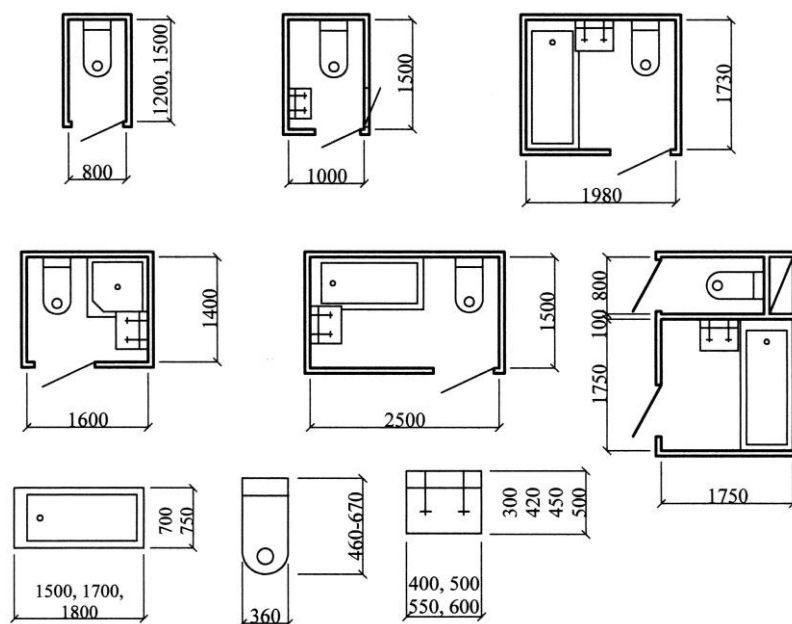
Планировочные схемы санузлов и размеры санитарного оборудования
